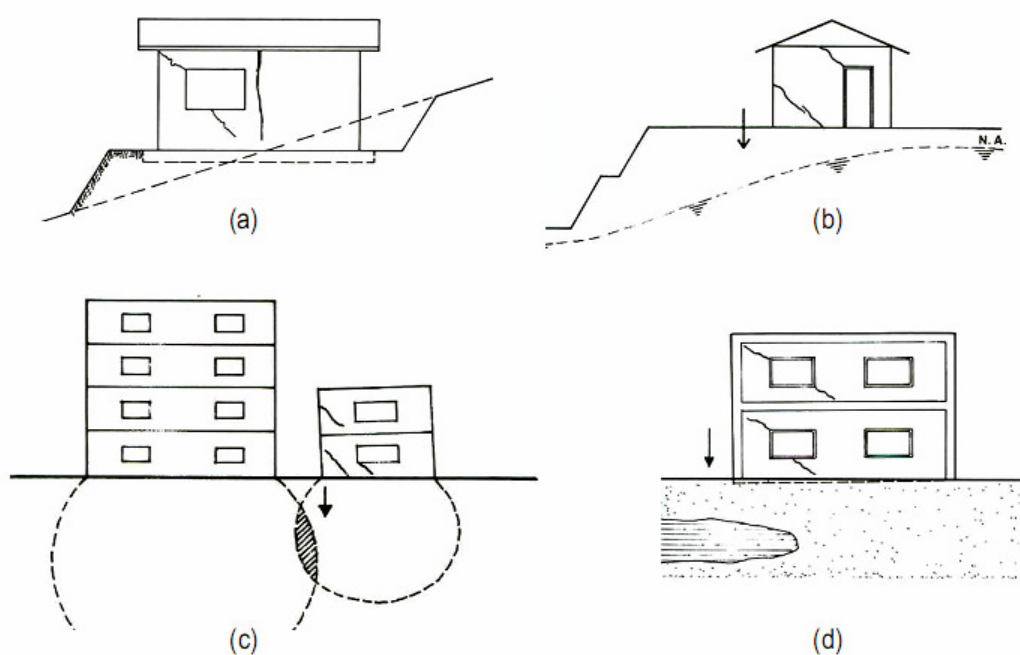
fissuras oriundas de recalque das fundações (THOMAZ, 1989, p. 96)
